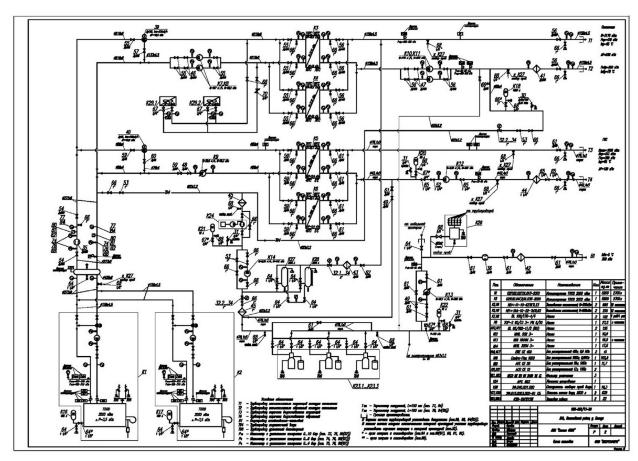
Тепловая схема котельной п. Беседа.
